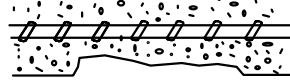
上部構造（RC・PC共通）のひび割れ位置およびパターン
